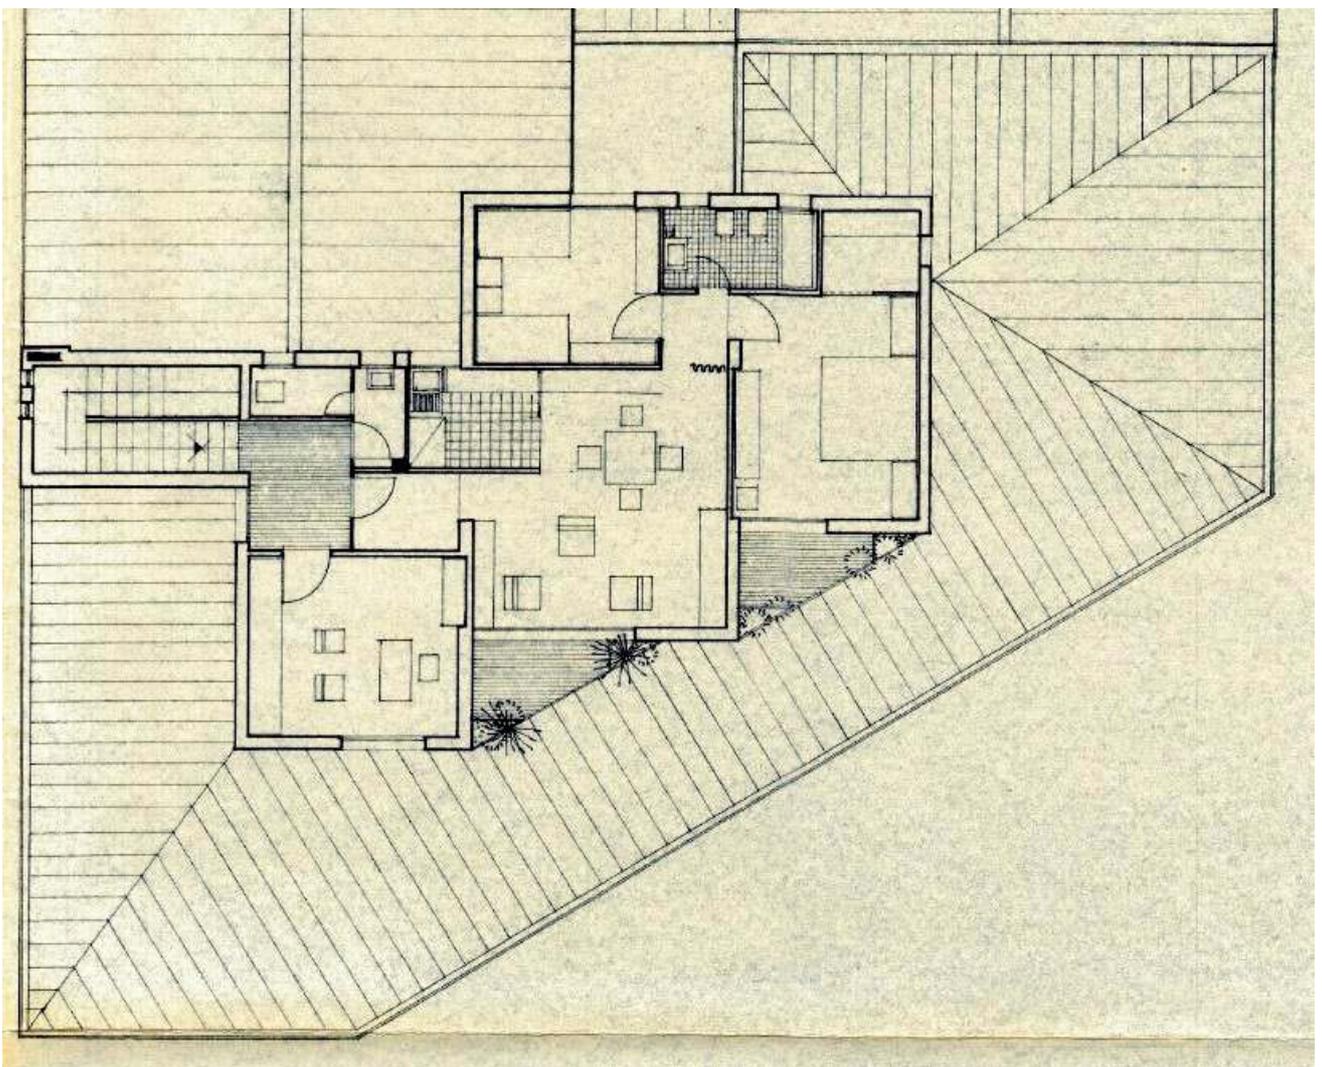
pianta piano terra con porzioni condonate (*fuori scala*)
